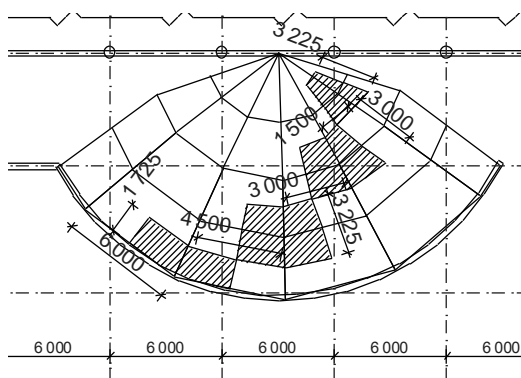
Грузовая площадь на n-й узел фермы
